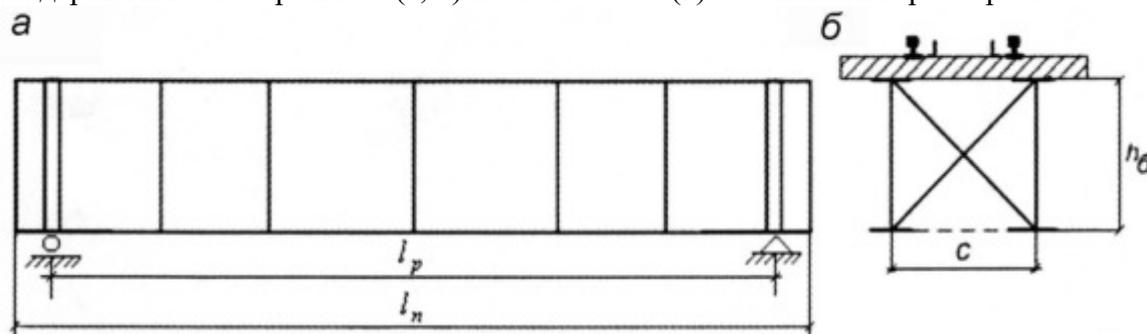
Схема металлического пролетного строения со сплошными главными балками: а – фасад пролета; б – поперечное сечение пролета
